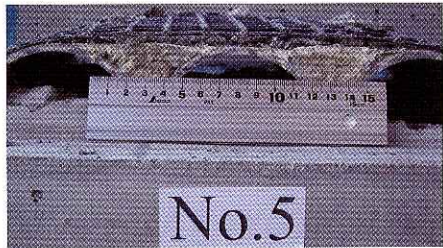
土のう部(平滑)断面(試験体 No.5)
